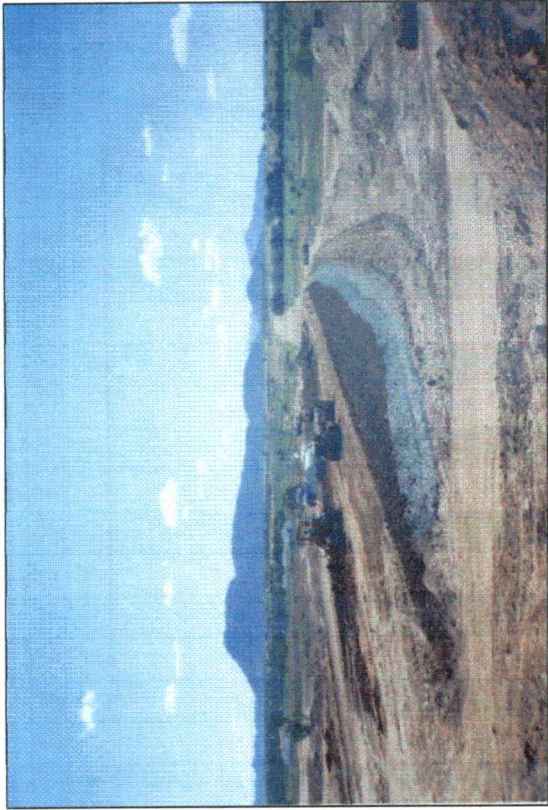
Vista panorâmica de execução do maciço.
